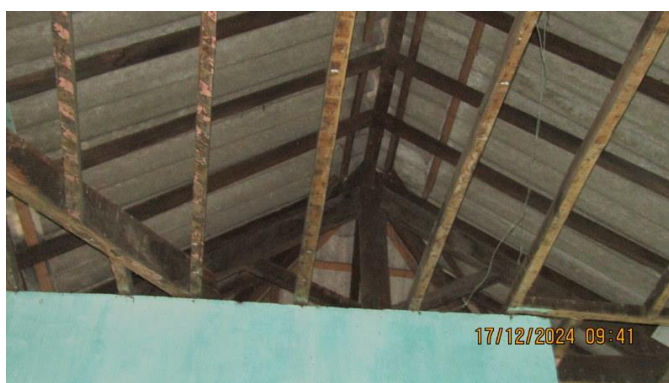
Outro detalhe da estrutura do telhado do imóvel "B".
